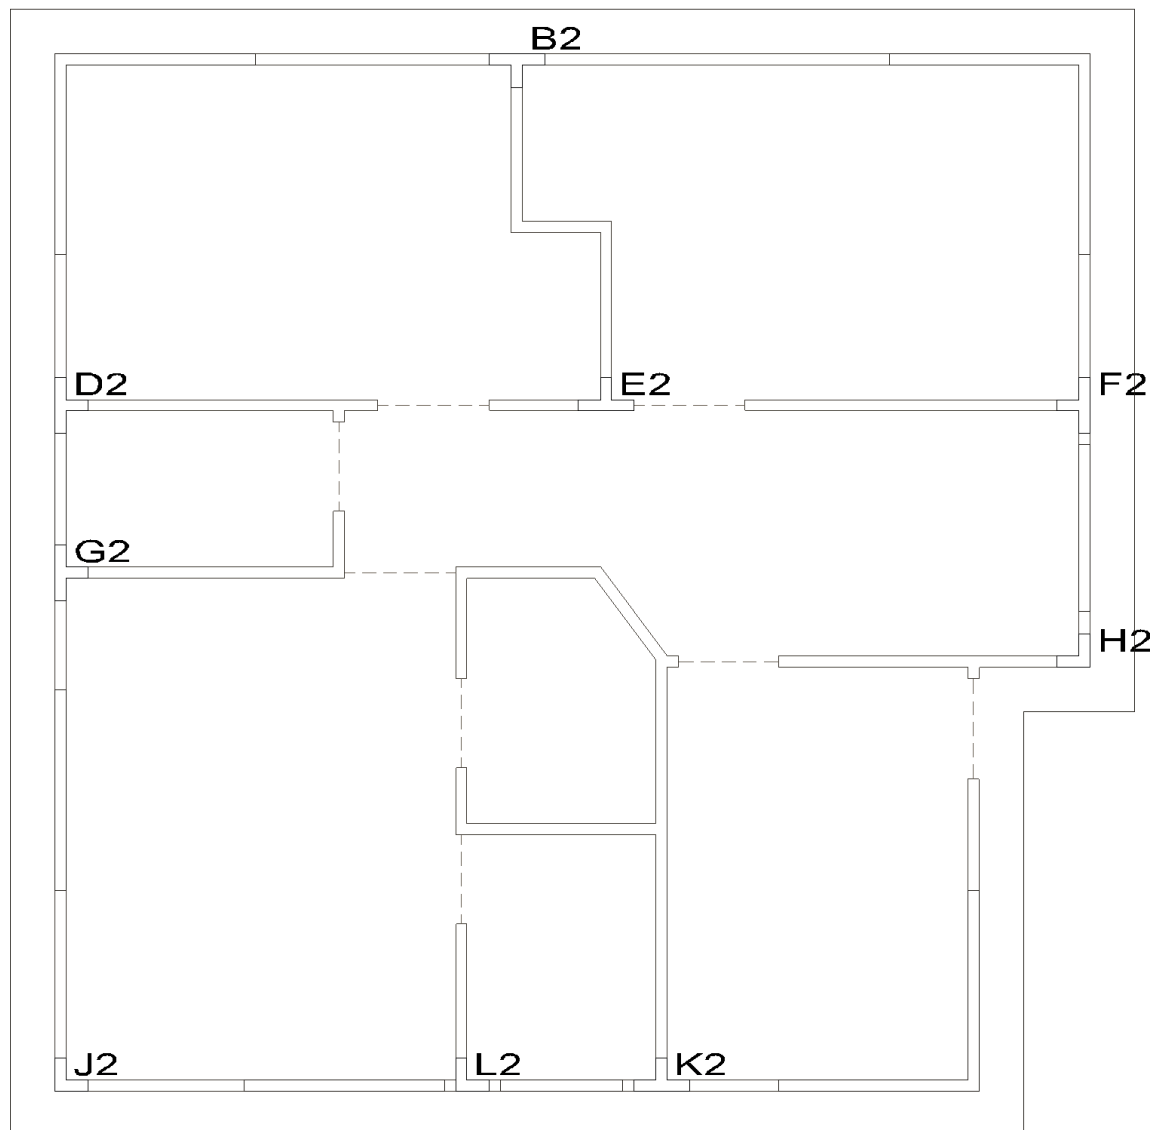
Ubicación de seudo columnas a reforzarse en los N+5.20m
